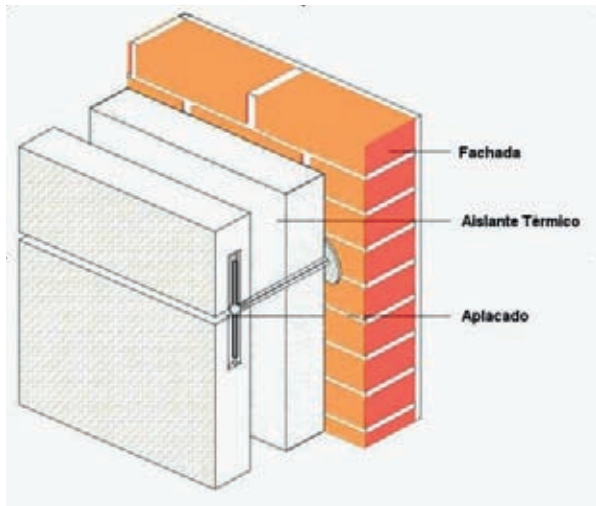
Esquema básico de la rehabilitación con aislamiento por el exterior de un sistema de fachada ventilada.
